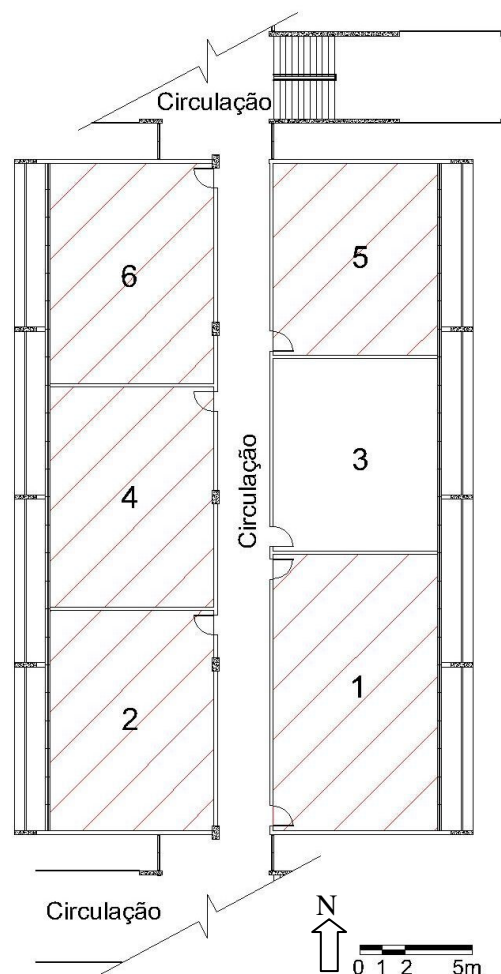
Planta do 1º pavimento do ICEB1 com marcação das salas utilizadas.
